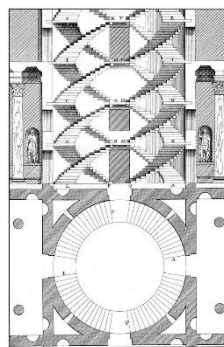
Alçado e planta de escadas em caracol de Palladio (Palladio, 1570)
